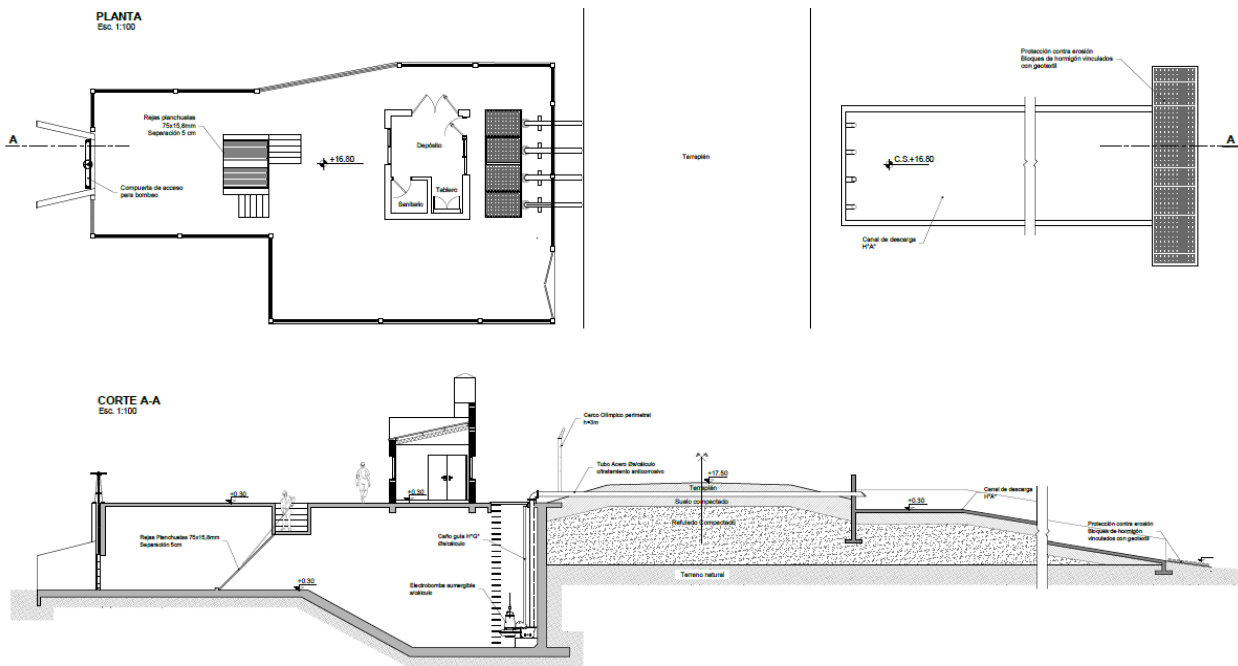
Esquema de estaciones de bombeo 1 y 2. Ver Planimetría: Plano N°13.
